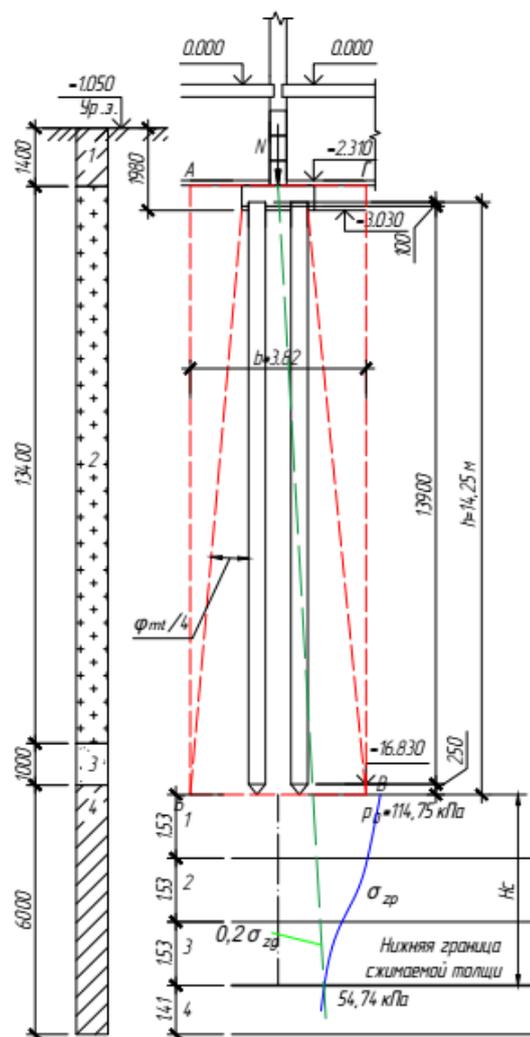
Расчетная схема осадки свайного фундамента
